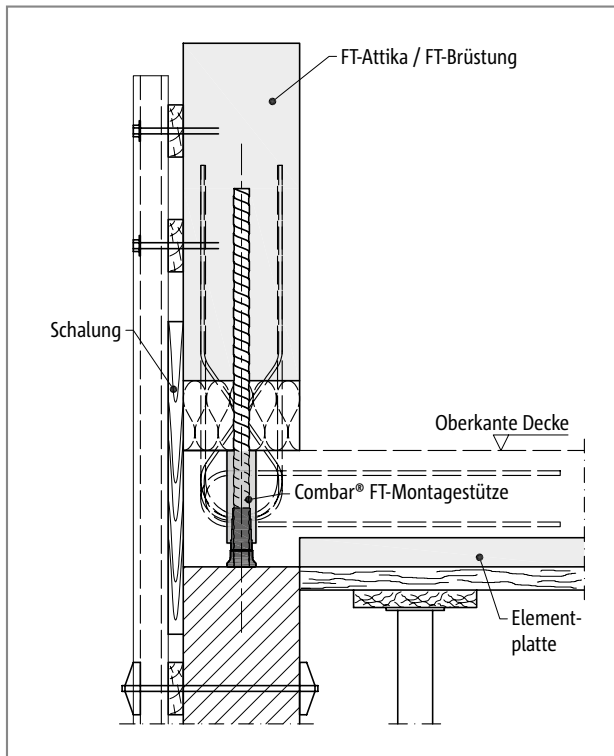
Schöck Combar® FT-Montagesätze: Einbau einer Fertigteilattika; Schnitt
